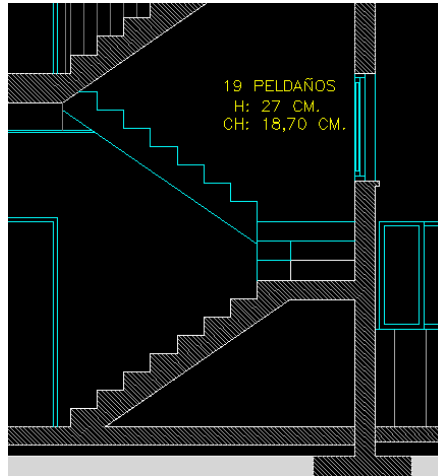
Obtenida de los planos de proyecto. Escalares de acceso a las zonas comunes del edificio.
